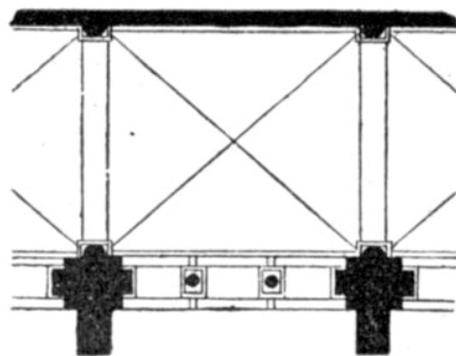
Grundriss eines Kreuzgangjoches
